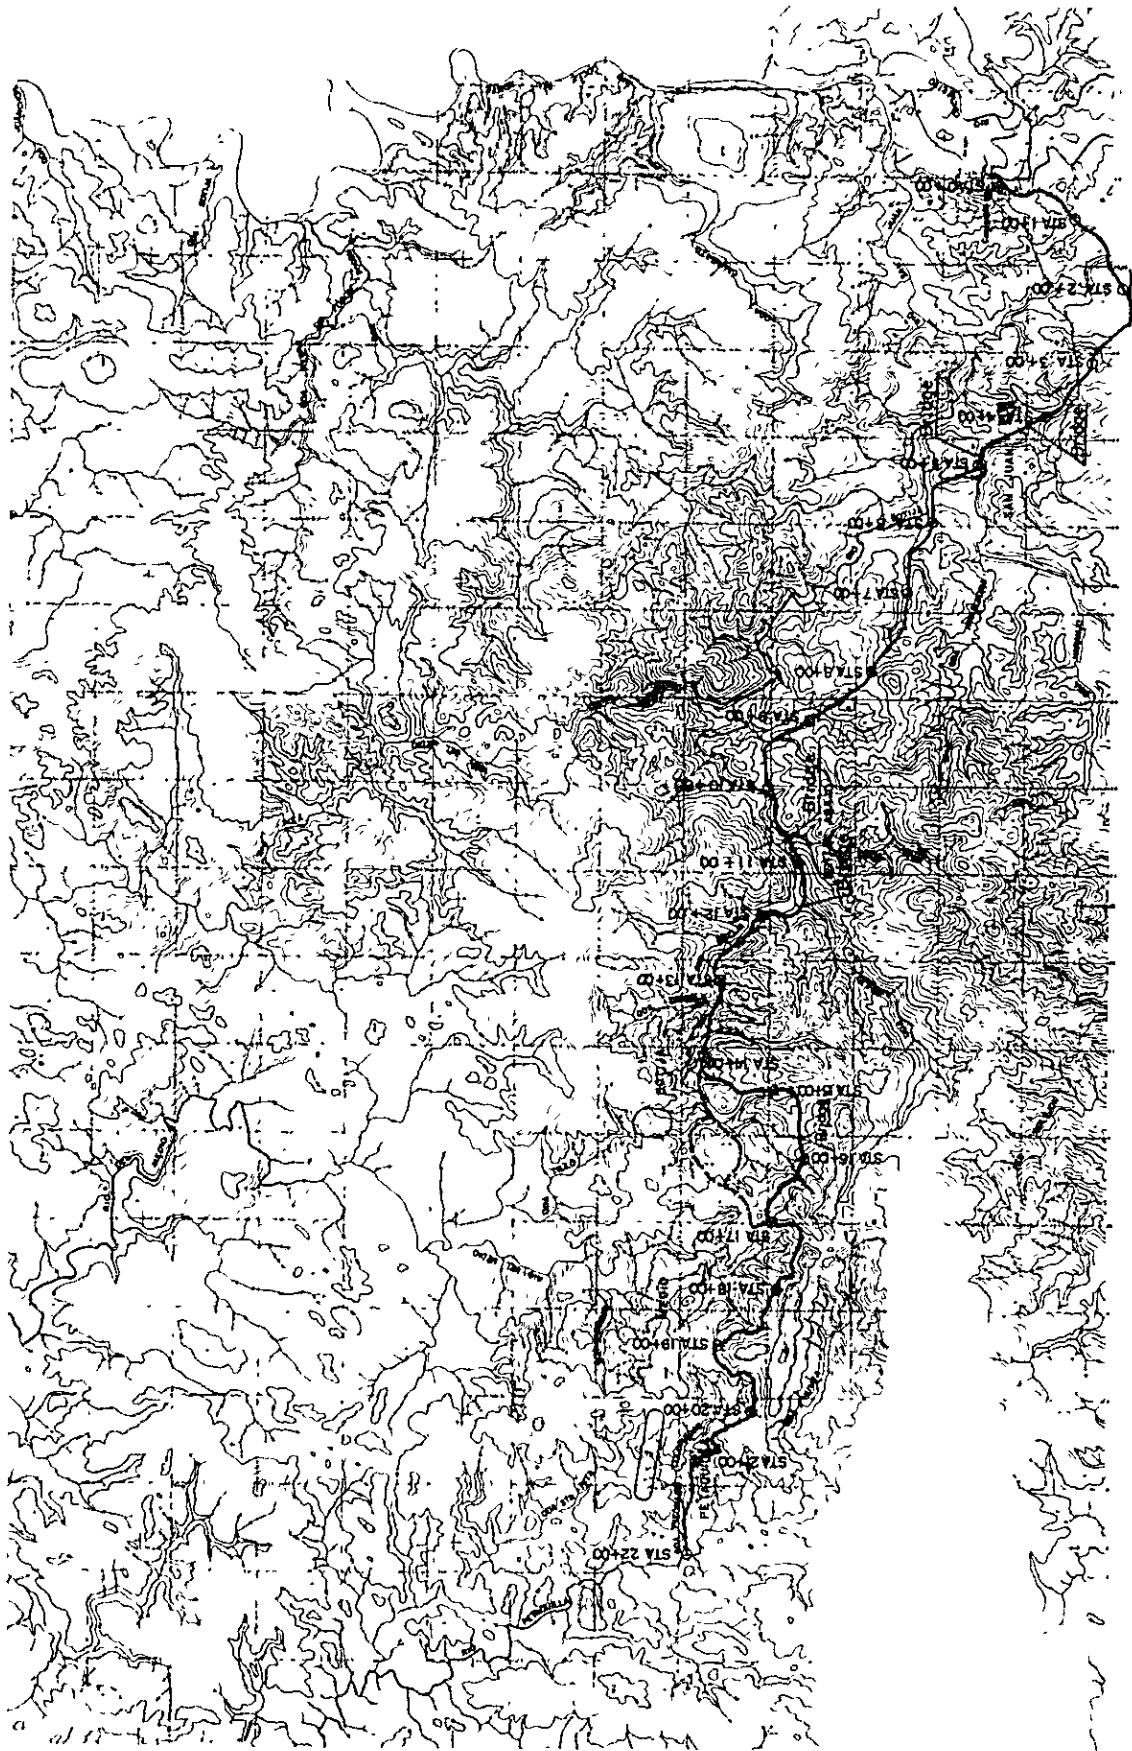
コレクショント〜ベタキージャ計画ルト平面図
